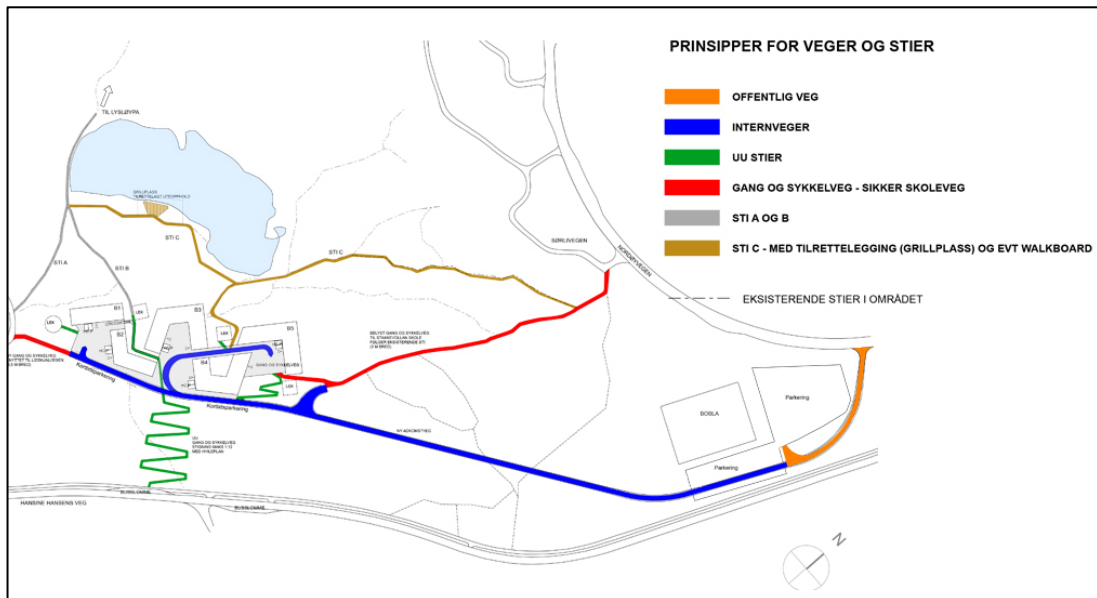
Prinsippskisse for planlagt parkeringsløsning ved ”bobla”. Illustrasjon: AT plan & arkitektur.
